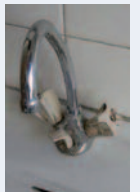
Exemple d'une robinetterie âgée, généralisée sur le bâtiment
